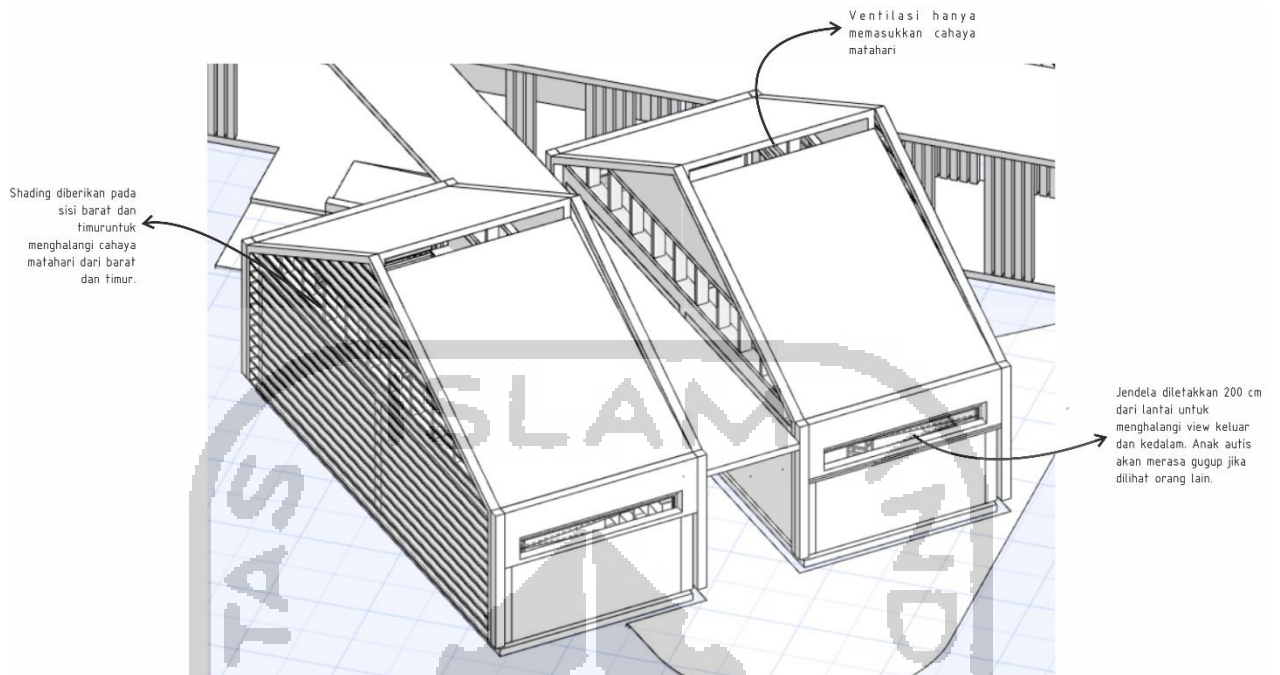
Konsep Denah Ruang Terapi Wicara
